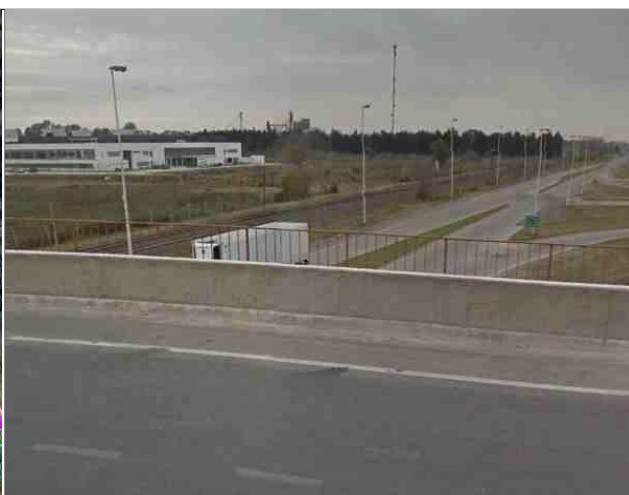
y Foto 213. Intersección RP N°6 con RP N°205
